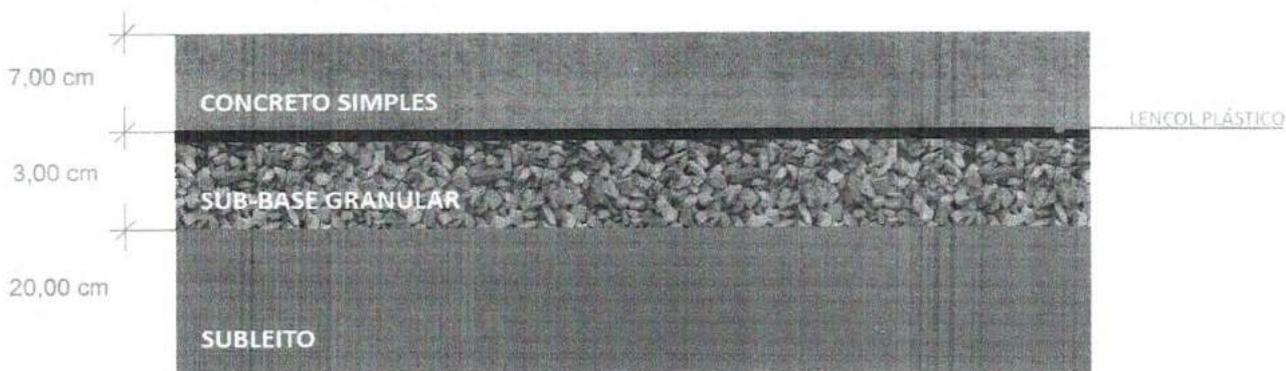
Seção genérica das camadas do pavimento de concreto simples.
